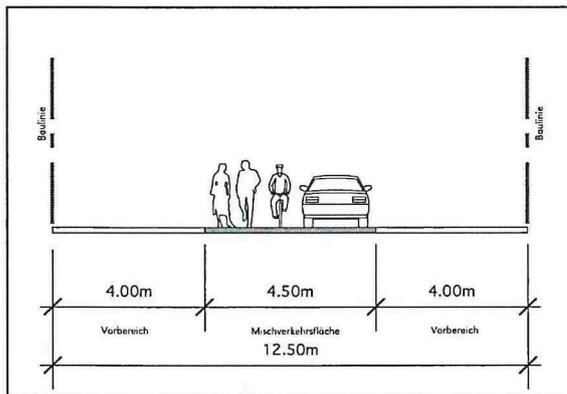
Querschnitt Zufahrtsstrasse 1/200
